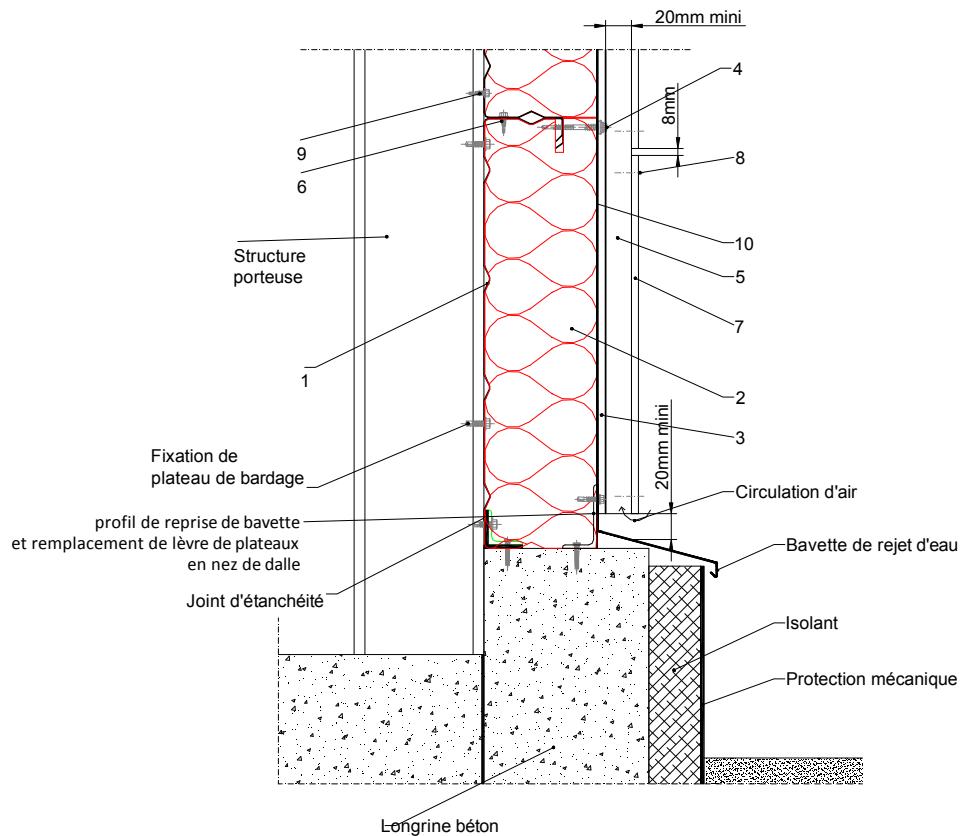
Bas de bardage – Coupe verticale – Pose en appui
